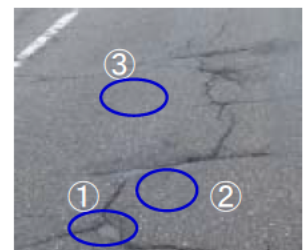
ひび割れ周辺の FWD 載荷位置
